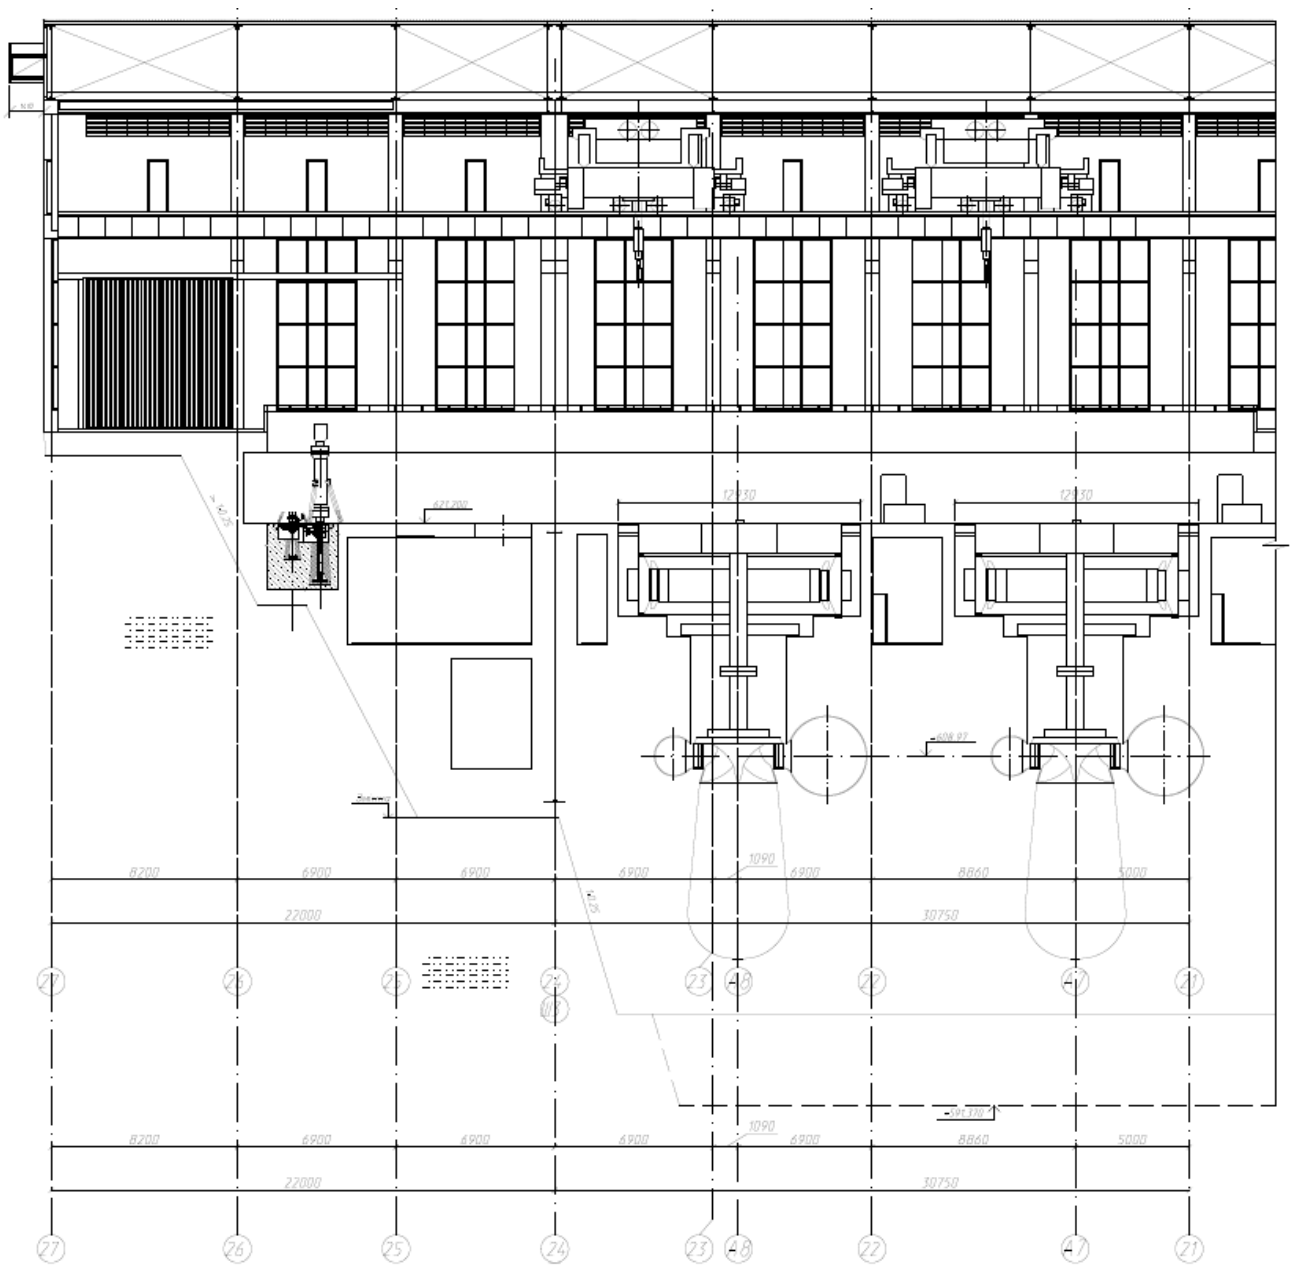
Поздовжній переріз по осі агрегатів будівлі ГЕС пригребельного типу на скельній основі
